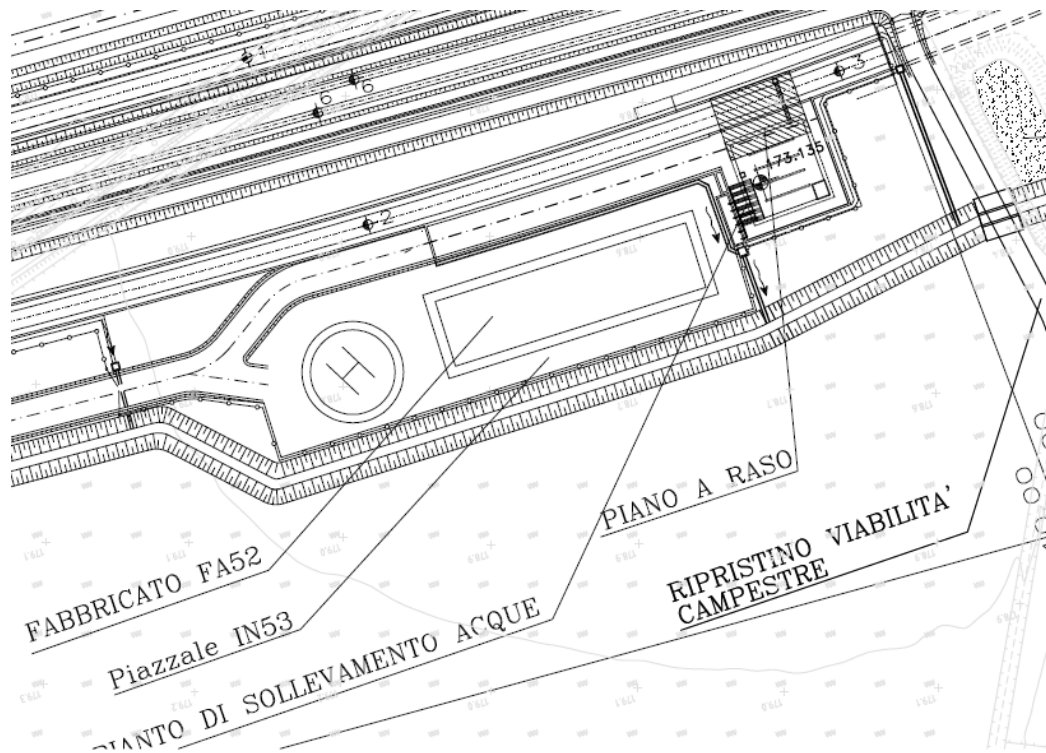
Planimetria piazzale di emergenza imbocco Shunt lato pari
